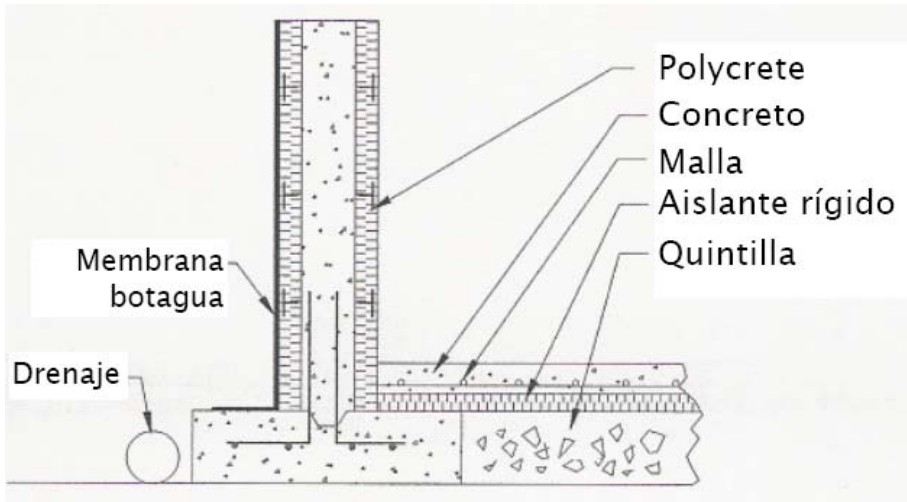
a. Conexión de la losa sobre el suelo a la pared de fundación
